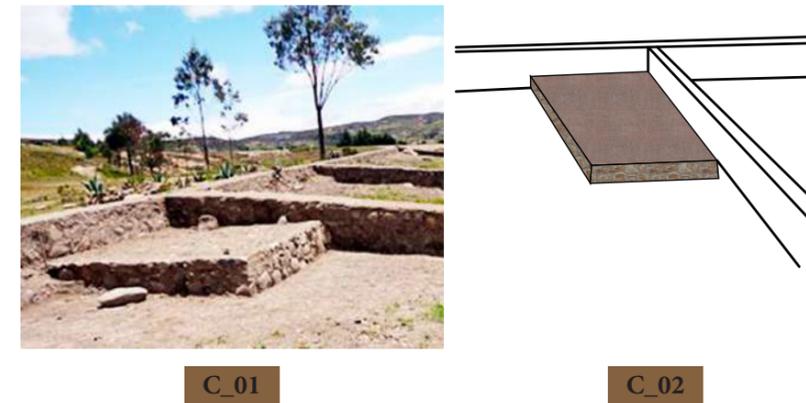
PLANTA DE LAS KALLANACAS, RUINAS DE DUMAPARA .
